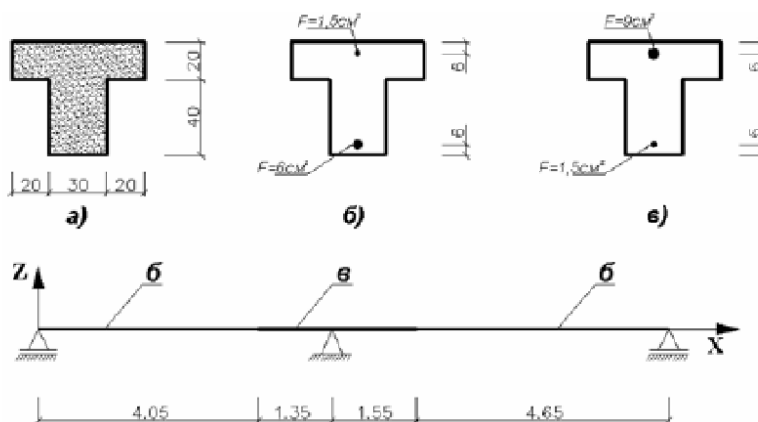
Перерізи елементів балки а) розміри перерізу, б) пролітний переріз, в) опорний переріз.
